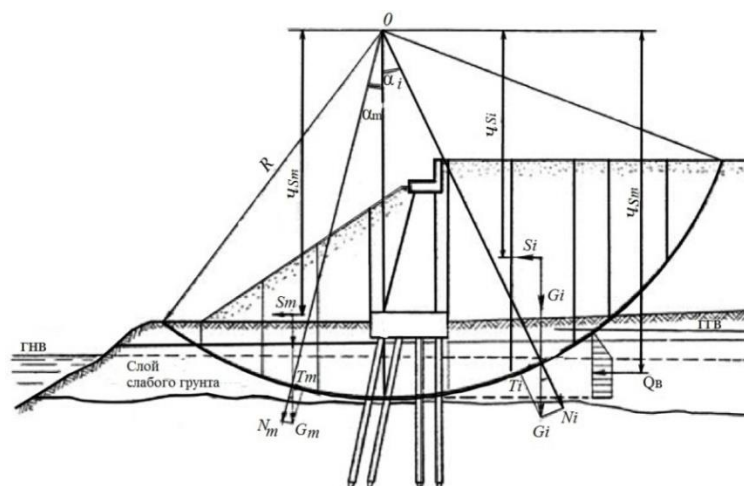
Схема к расчету устоев на устойчивость против глубокого сдвига совместно с грунтом по круглоцилиндрической поверхности
